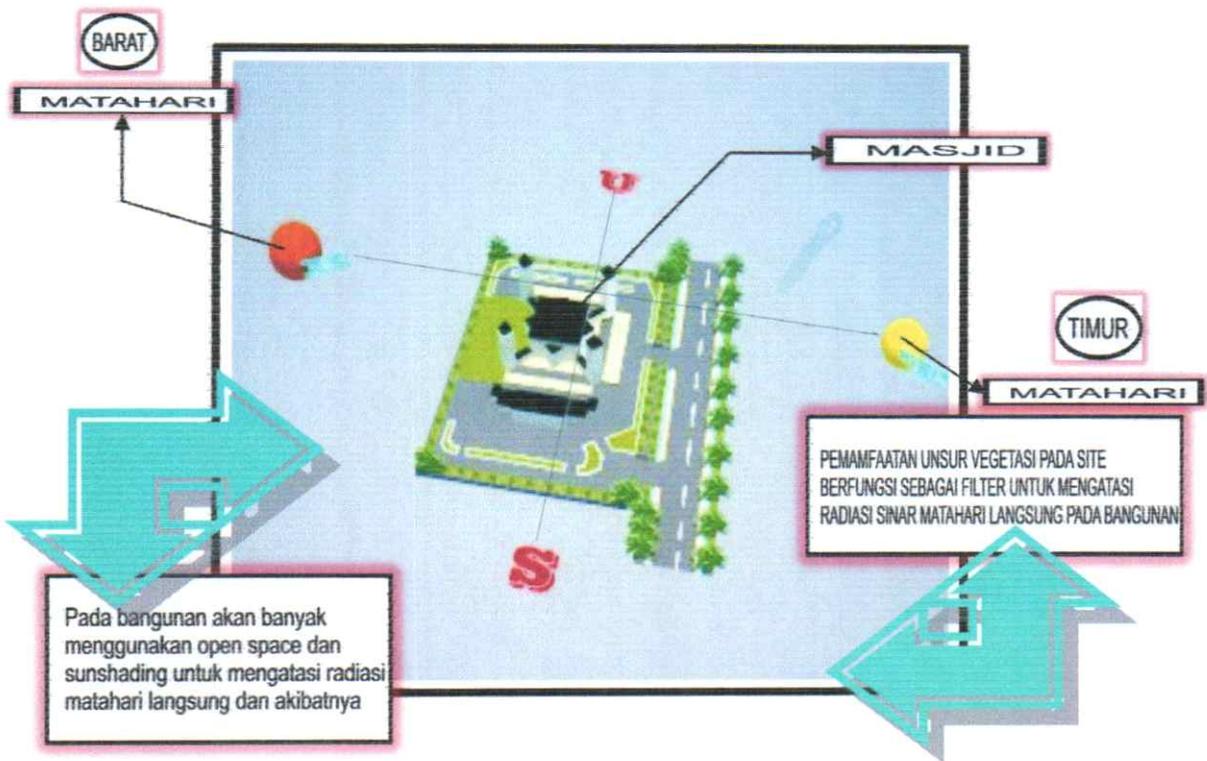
Sketsa Bentuk Bangunan Tropis
